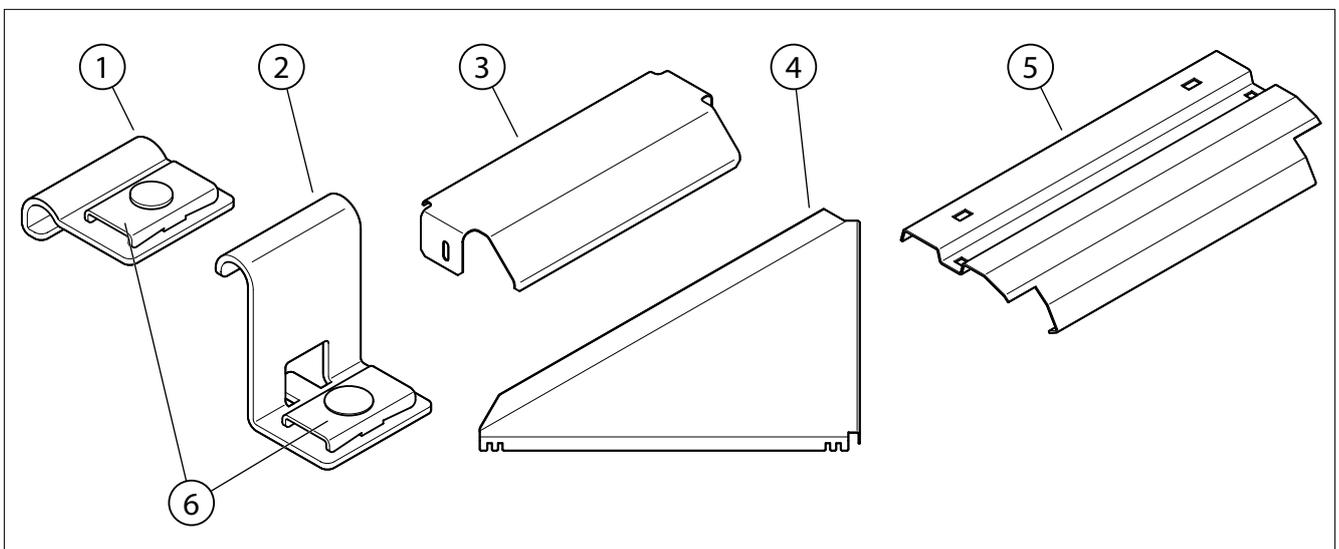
Anschlussstück/Auflagewinkel/Abgangsblech
